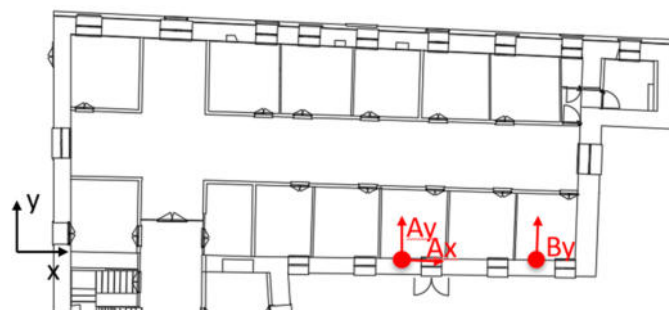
Disposizione accelerometri nel piano primo dell'edificio.
